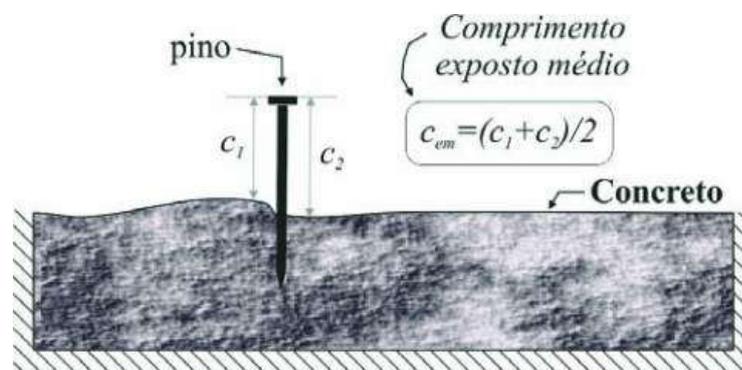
Ensaio de cravação de pinos (IBRACON, 2012)
